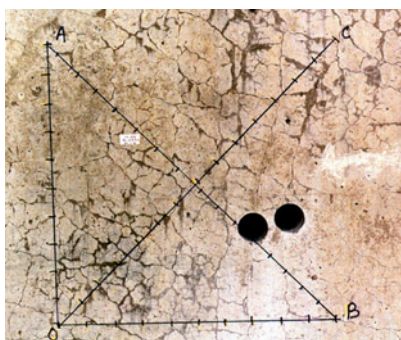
Exemple d'implantation d'un repère de suivi de fissuration sur un ouvrage
